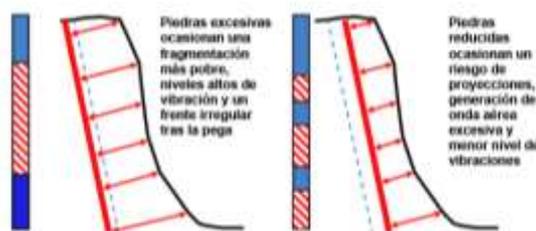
consecuencias posibles de piedras incorrectas en la voladura
